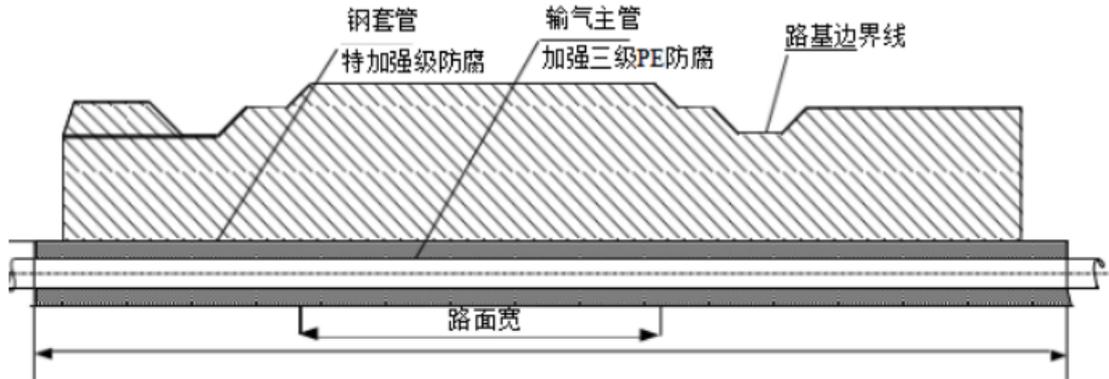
乡村水泥道路、机耕道穿越施工方式断面示意图
